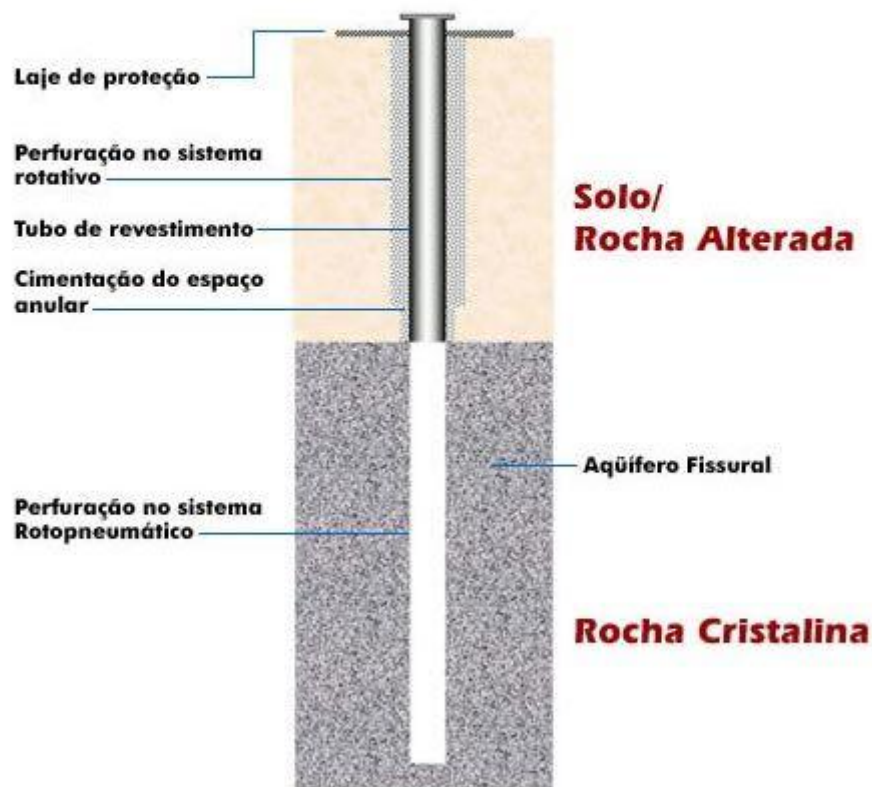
Perfil Geológico e Construtivo do Poço Tubular
